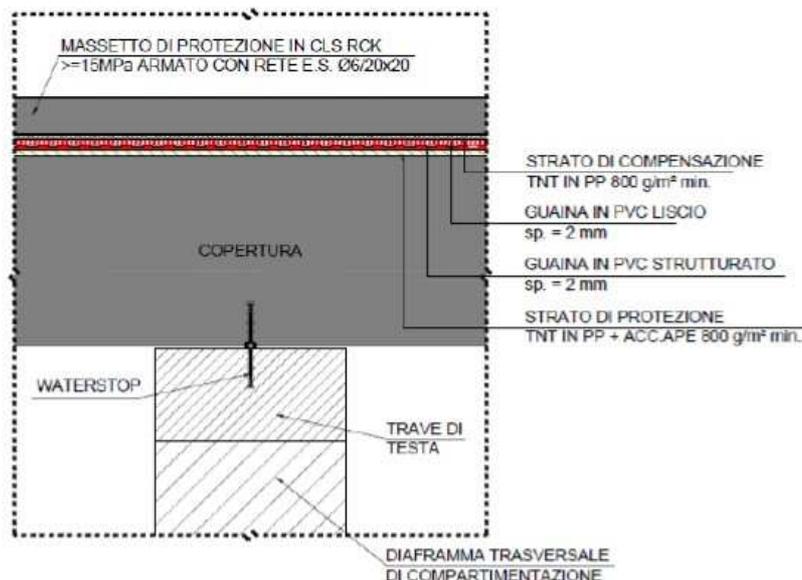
Particolare del pacchetto di impermeabilizzazione del solettone di copertura con la realizzazione del massetto di protezione.(da elaborato I.g)
